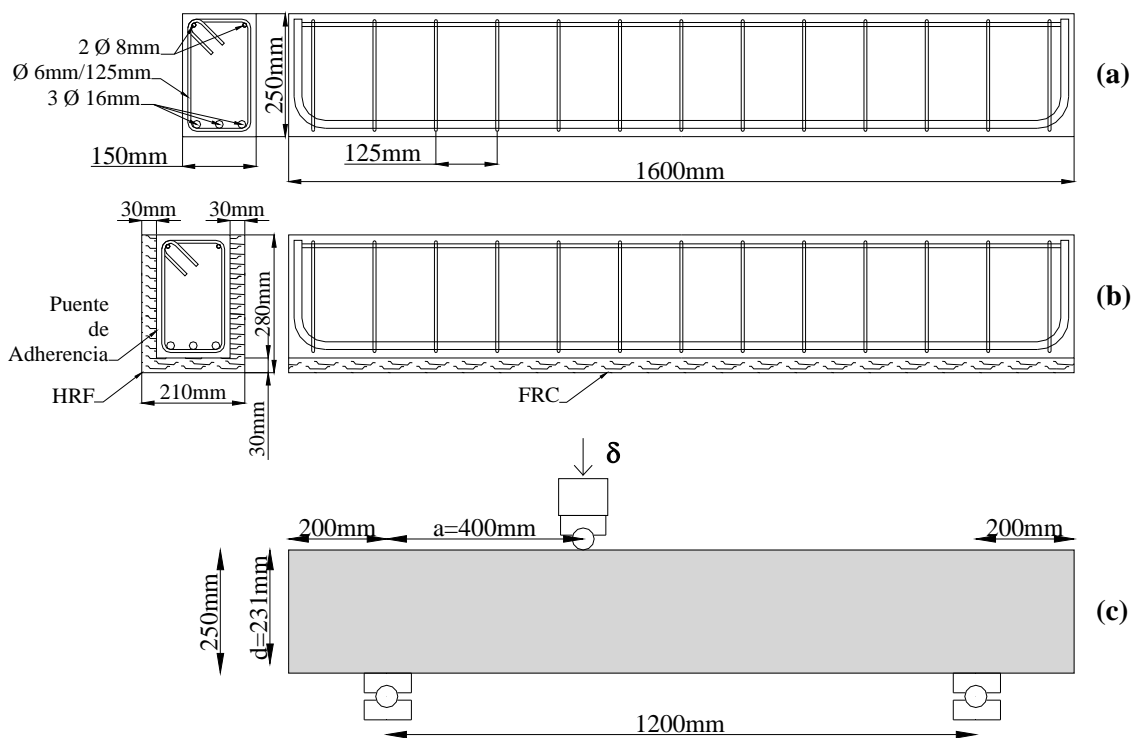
(a) Viga de hormigón Armado. (b) Viga reforzada/reparada. (c) Configuración de ensayo.
